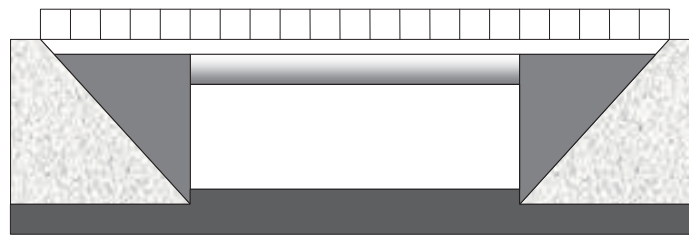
secciones trasversales tipo en tableros losa de ala ancha
